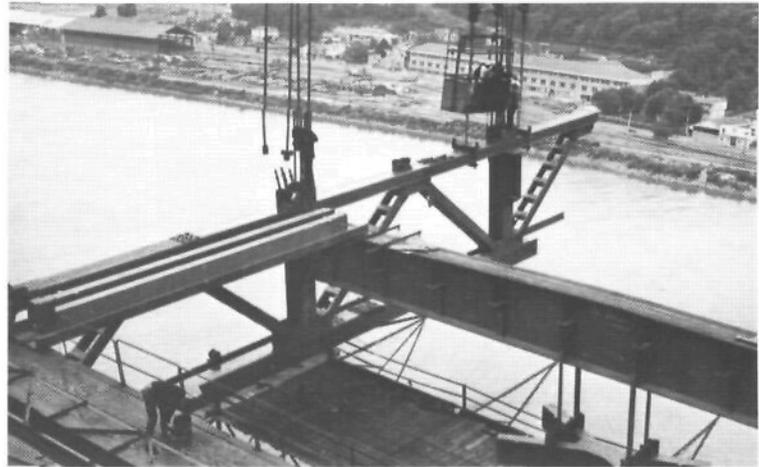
Pont sur le Forth. Construction de la poutre de rigidité à partir des appuis. Le câble n'a pas encore sa position d'équilibre, et ne présente donc pas sa flèche maximum au centre.
